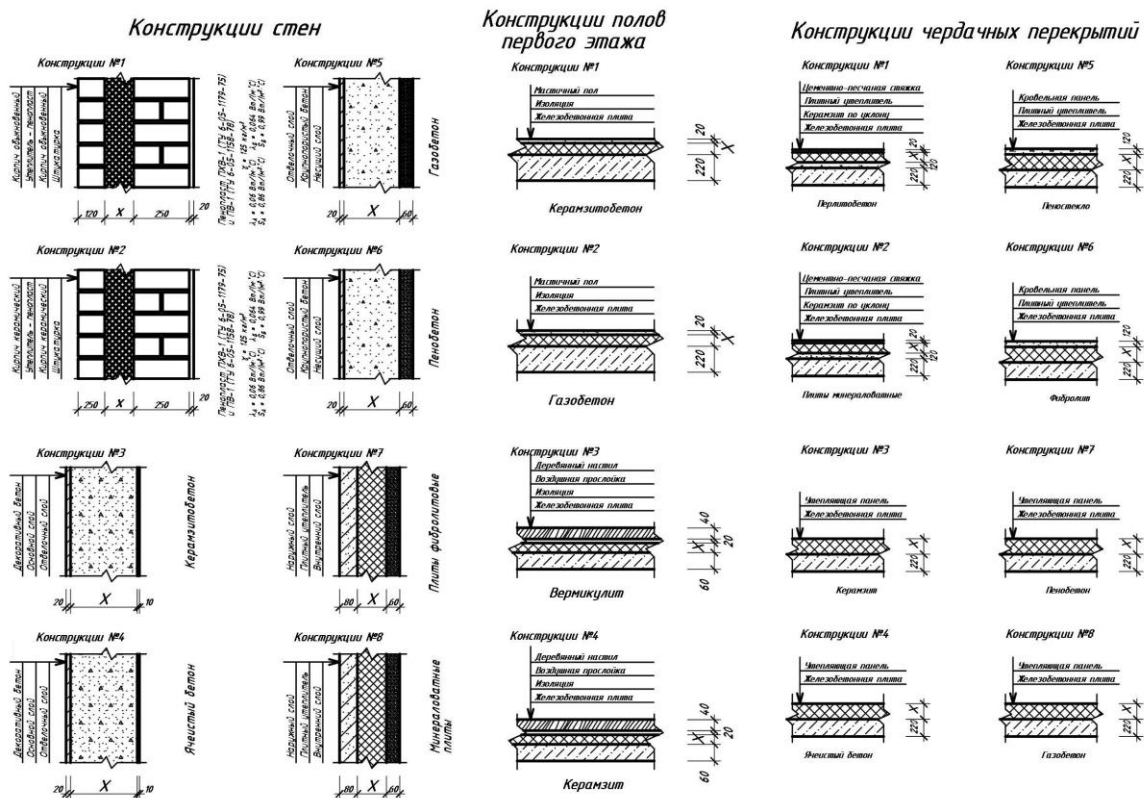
Конструкции ограждения (стен, полов первого этажа, чердачных перекрытий)
